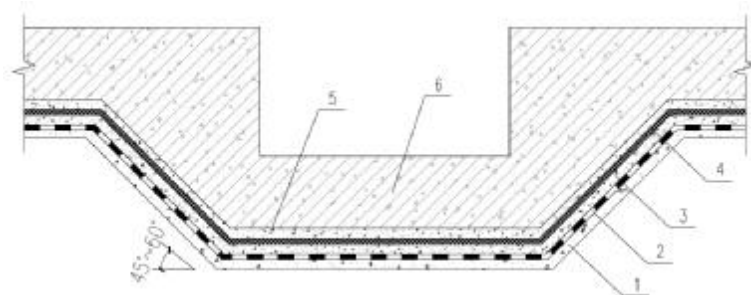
基础底板不等高处隔振垫层施工构造图
